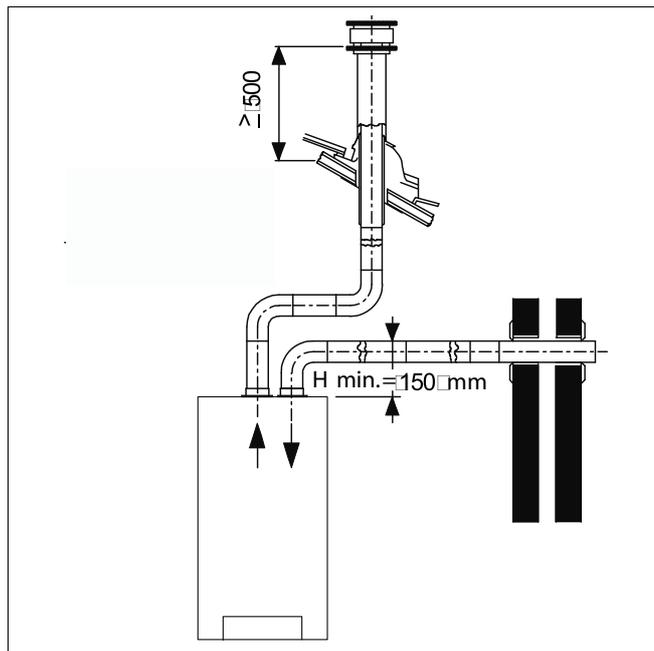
Aspirazione diretta dell'aria attraverso la parete esterna e scarico fumi a tetto (in mm).
